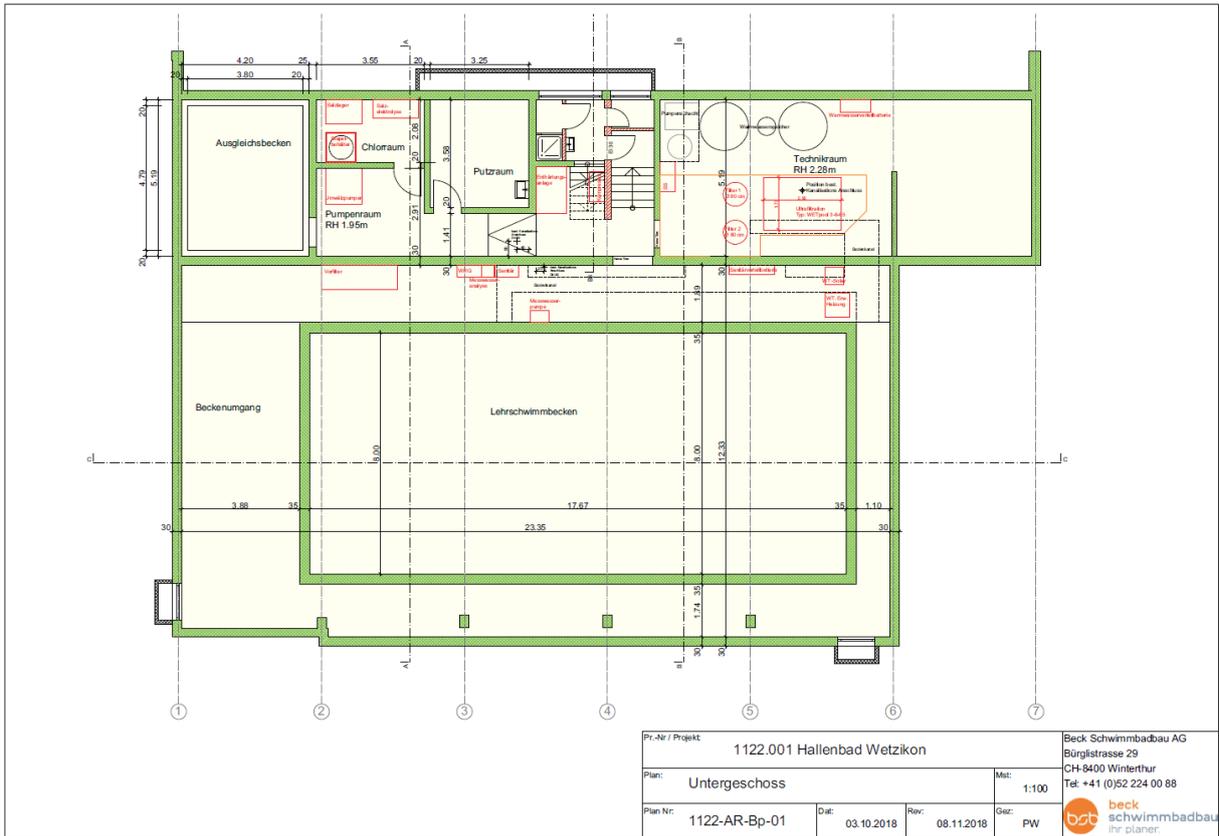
Grundriss Untergeschoss (Der Perimeter der Sanierung ist gelb markiert)
